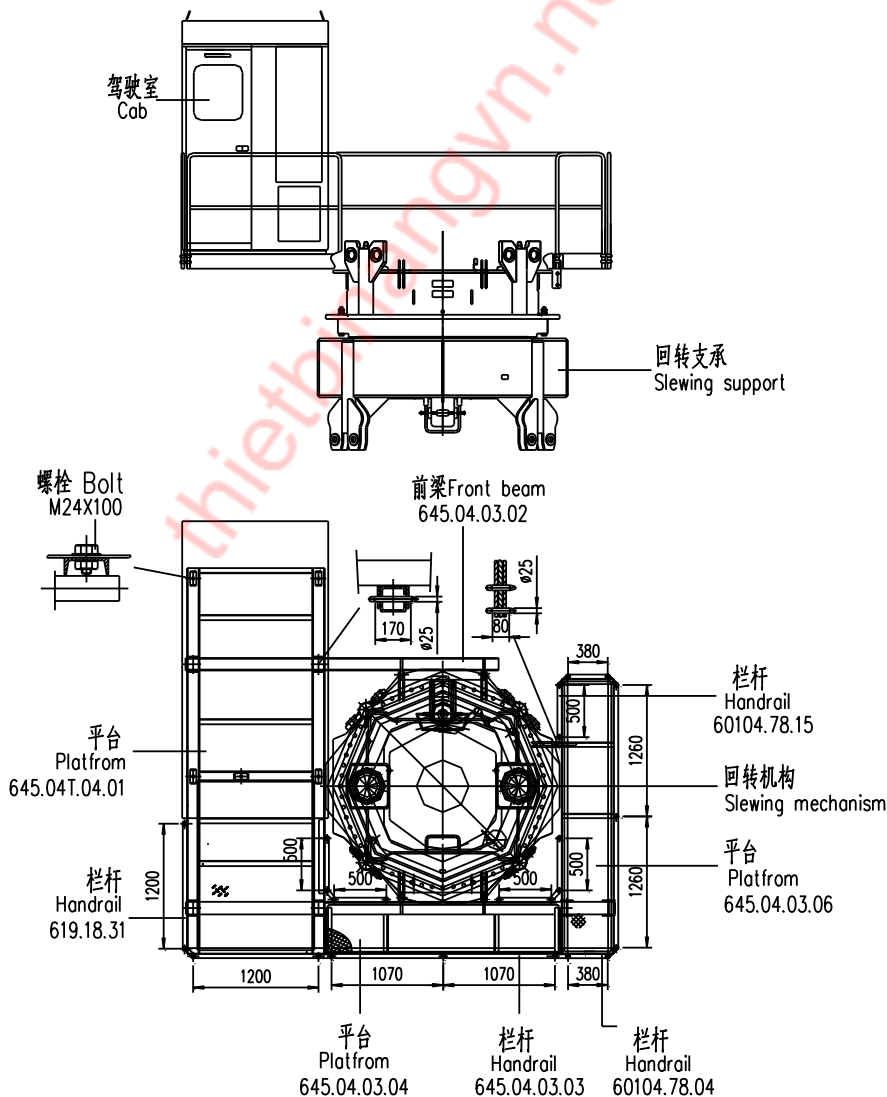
回转支承组件 Fig. 4-13 Slewing support assembly
